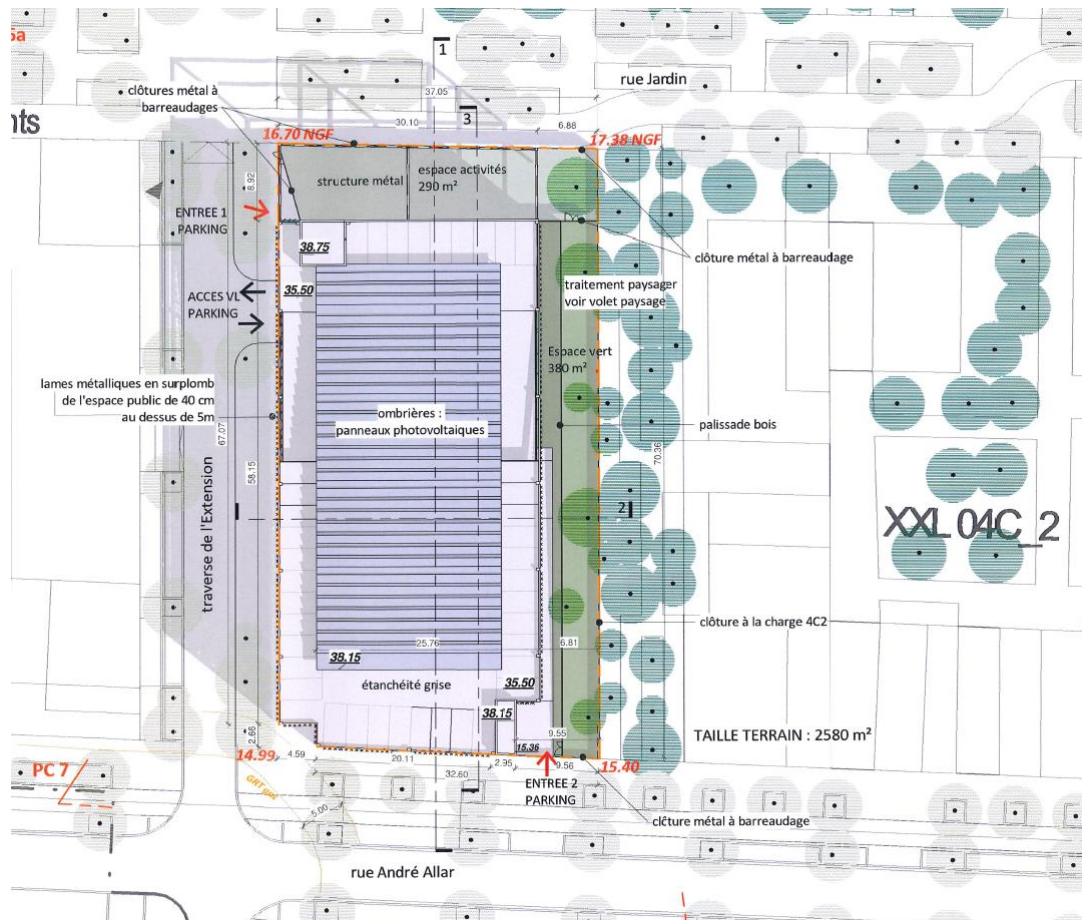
Plan masse avec les hauteurs de l'îlot 4C1
